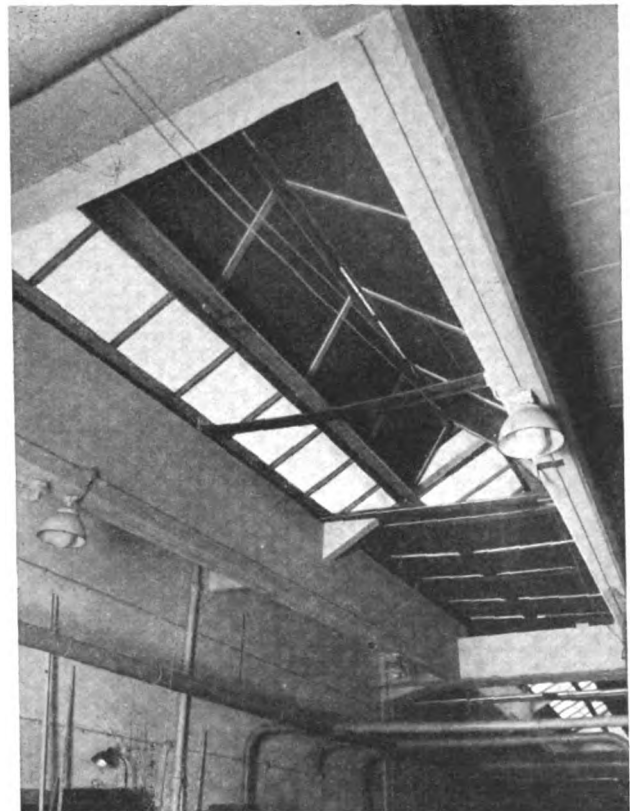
Fensterverdunkelung einer Flachbau-Werkhalle durch Klapprahmen, halbgeöffnet und geschlossen.
